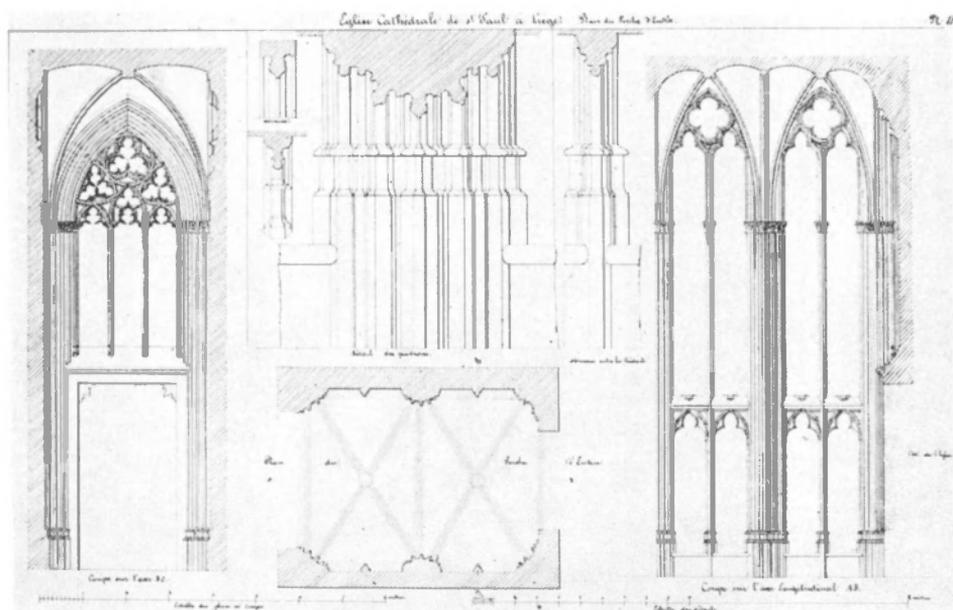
Plan, élévation, relevés et coupes du pilier engagé, de l'arc doubleau et des nervures.
